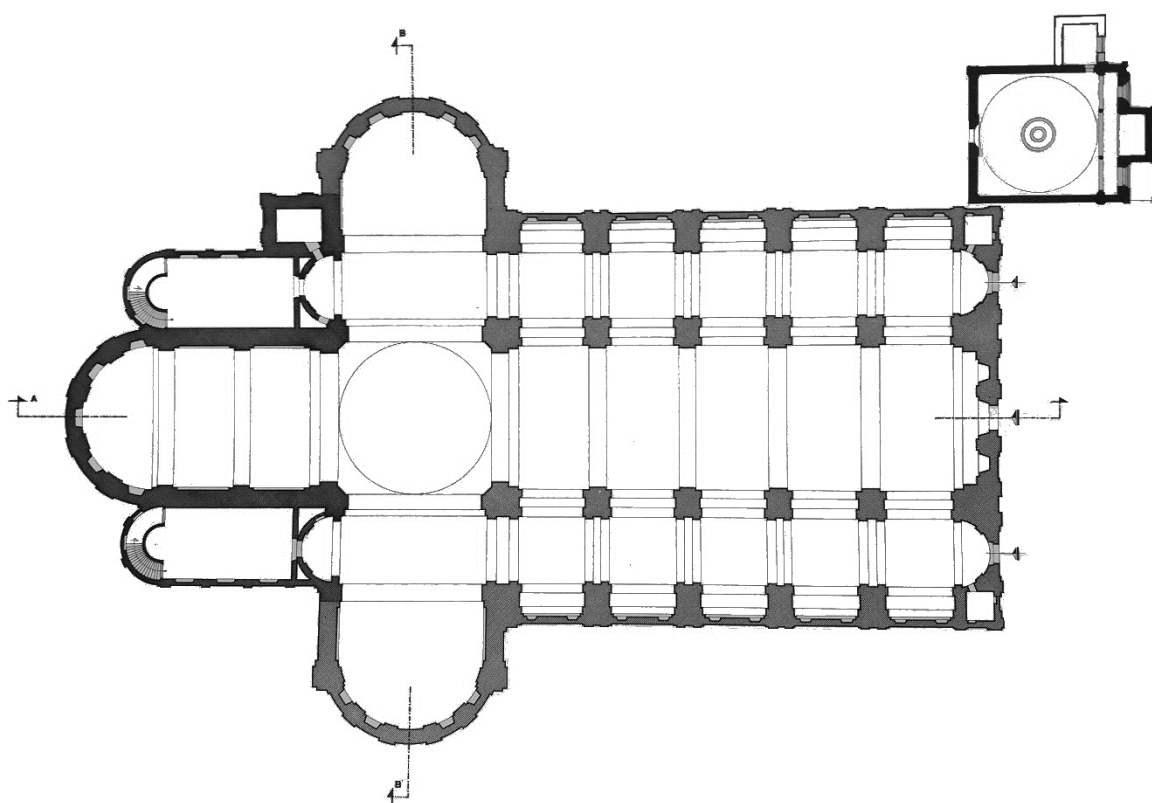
Pianta del progetto di Andrea da Valle per la Cattedrale di Santa Maria Assunta (Bresciani Alvarez, 1966)
